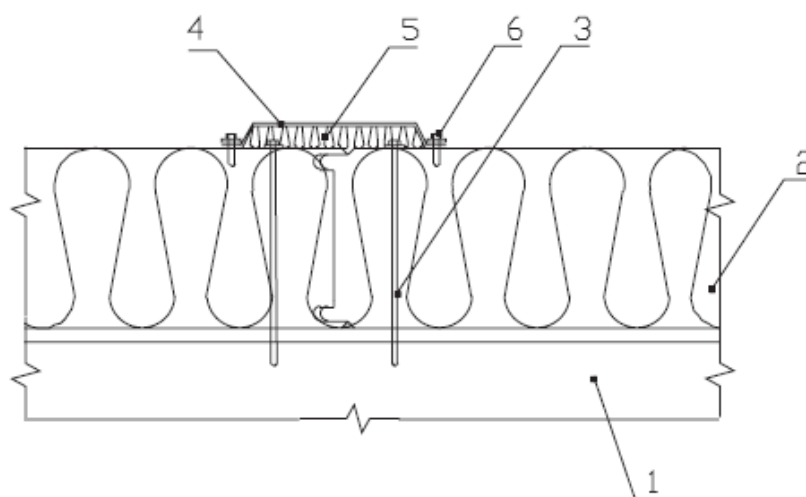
Крепление стеновых "сэндвич"-панелей с теплоизоляционным слоем из плит марки "ТЕРМО" к прогону при их горизонтальном расположении
